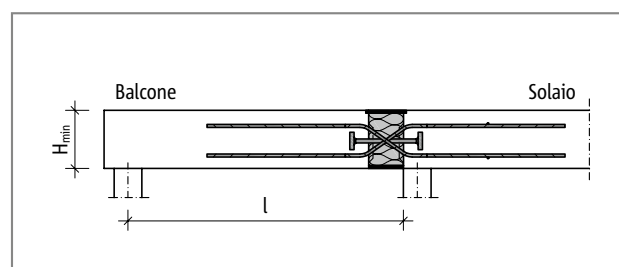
Schöck Isokorb® XT tipo QP-VV: schema statico
